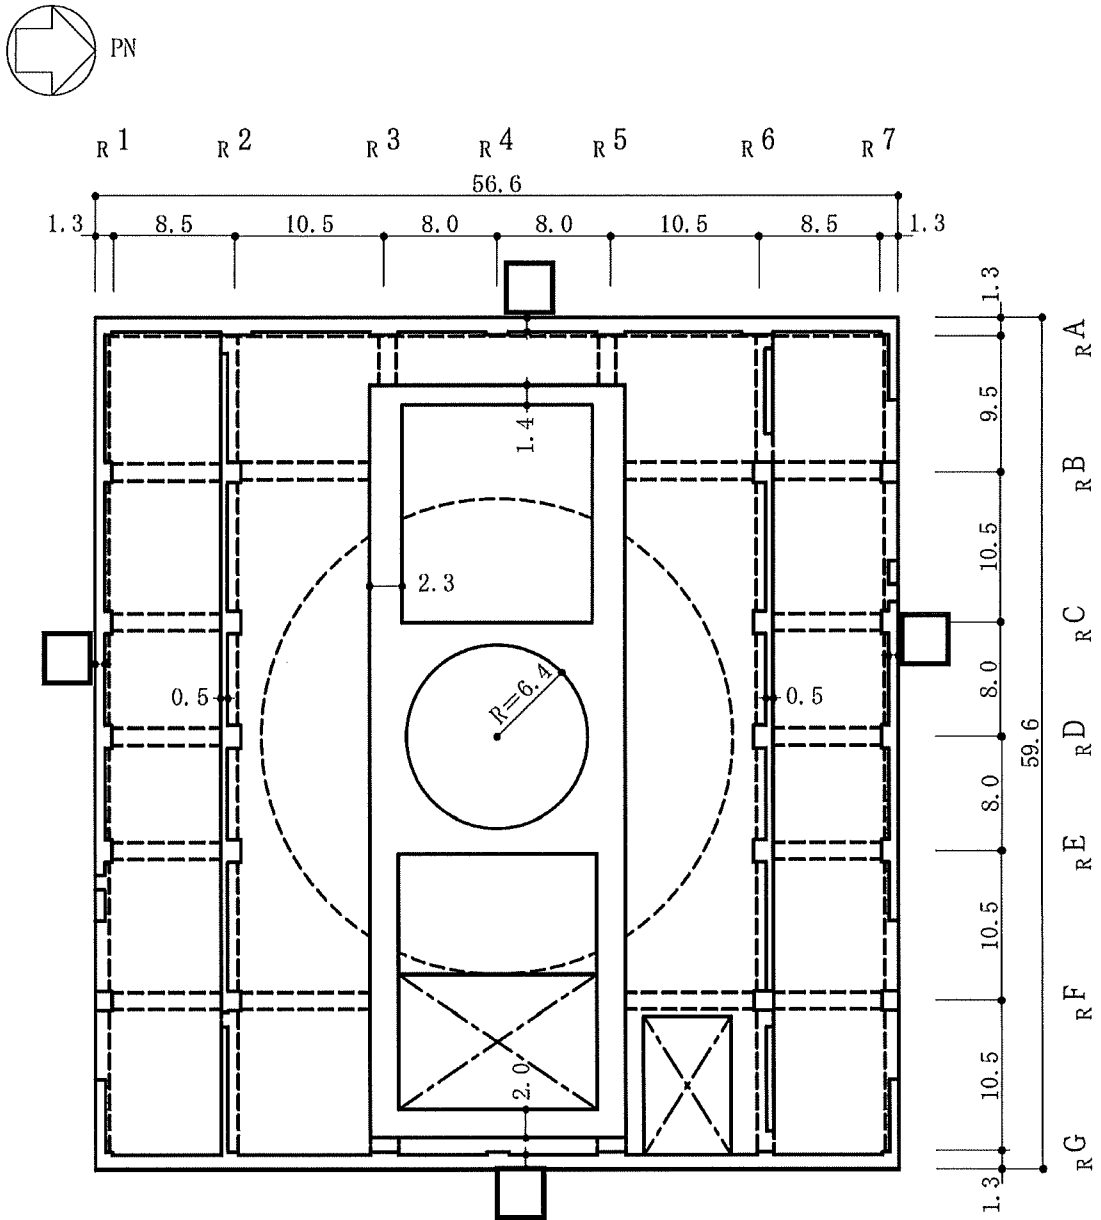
原子炉建屋の概略平面図 (1F, T.M.S.L. 12.3m) (4/9)
